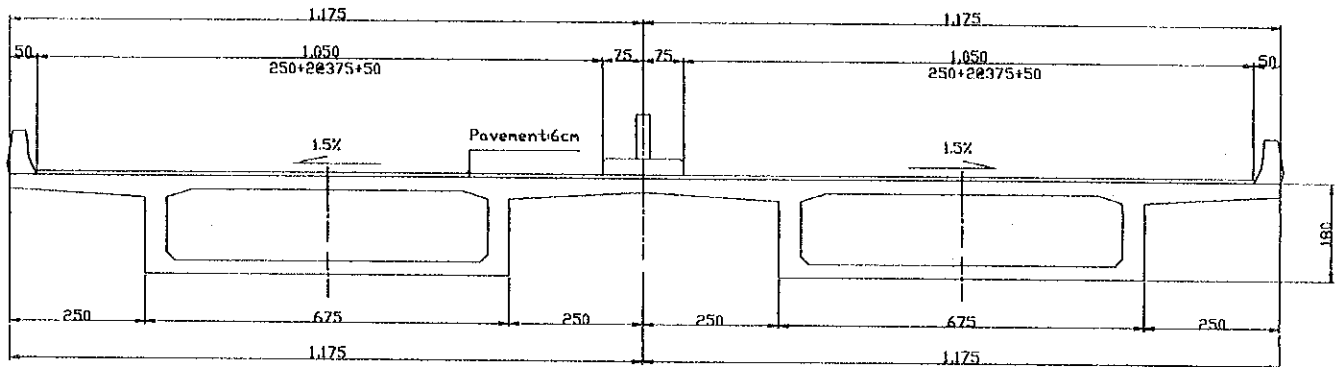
スパン $L_0=40\text{m}$: PCポステン箱桁橋の標準断面図
